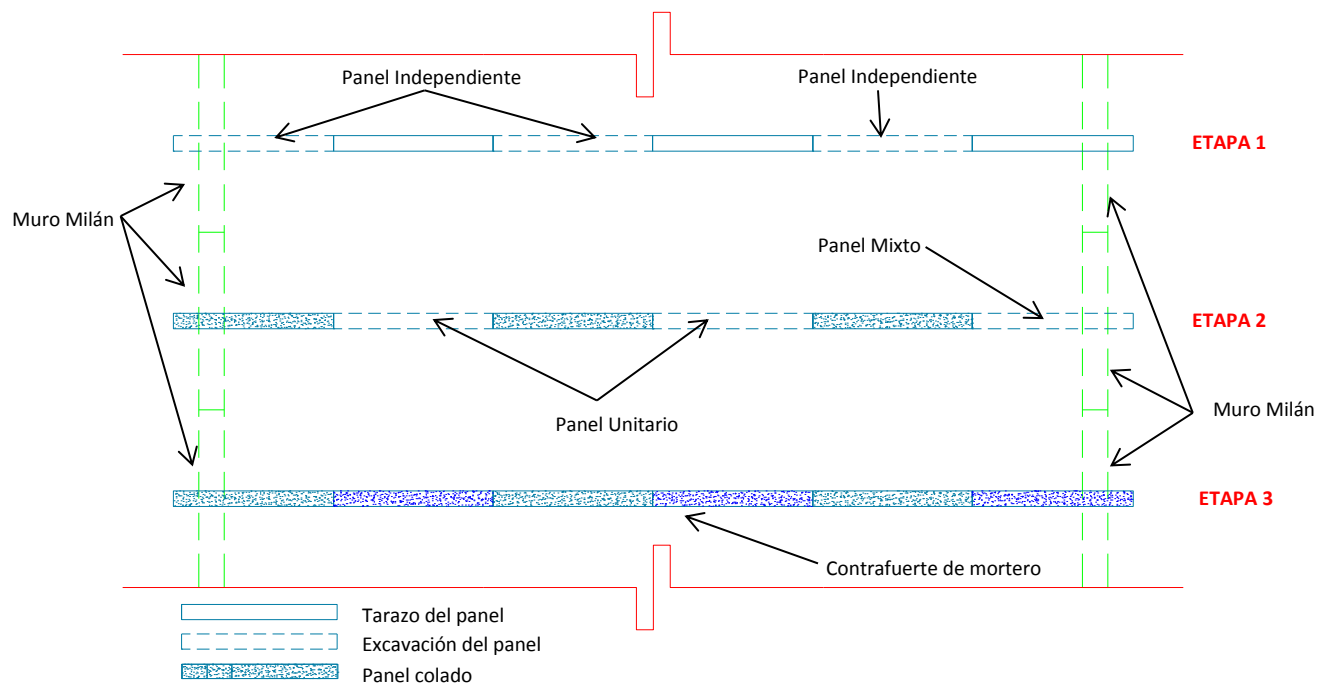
Secuencia de excavación y colado de un panel en la zanja del contrafuerte con Almeja Hidráulica. - Planta
